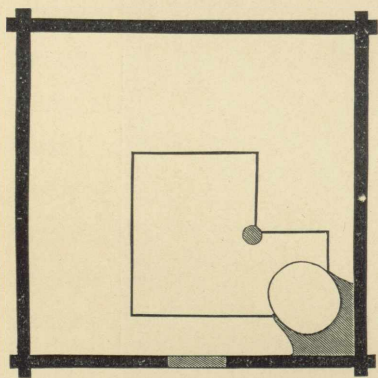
Grundriss einer alten Jurte bei den Zobeljurten.
